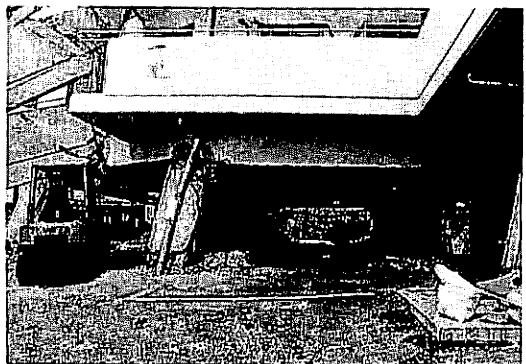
新耐震設計法(1981)による8階建てRC造集合住宅1階（ピロティ）の層崩壊
